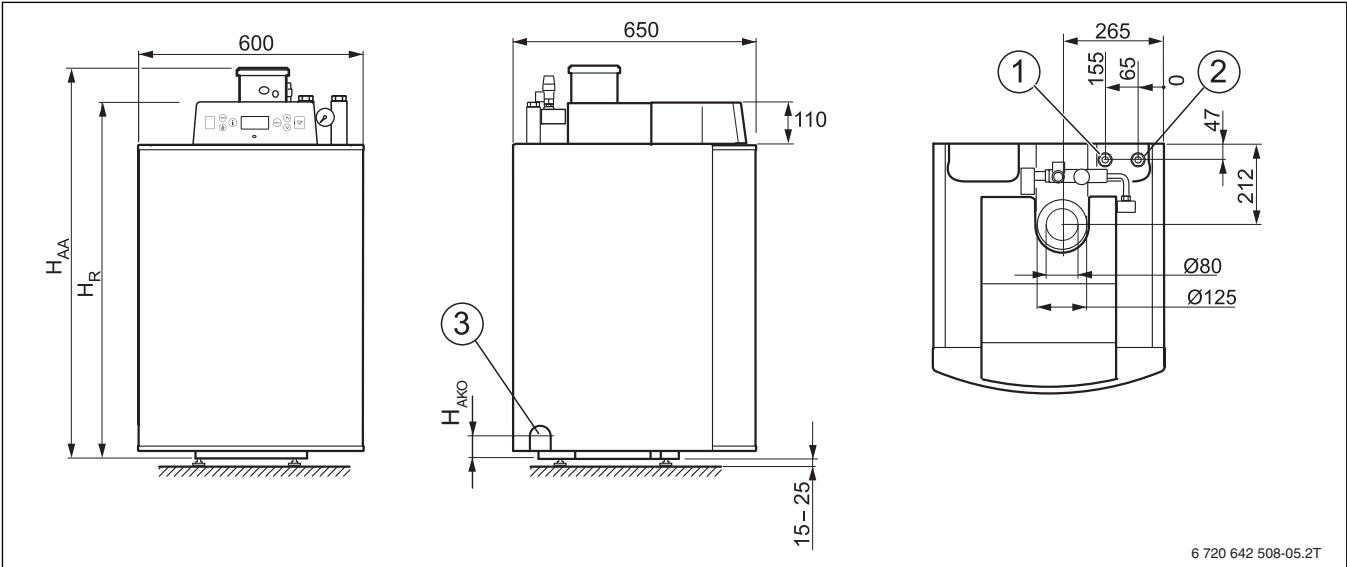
Anschlüsse und Abmessungen des Heizkessels (Maße in mm)
